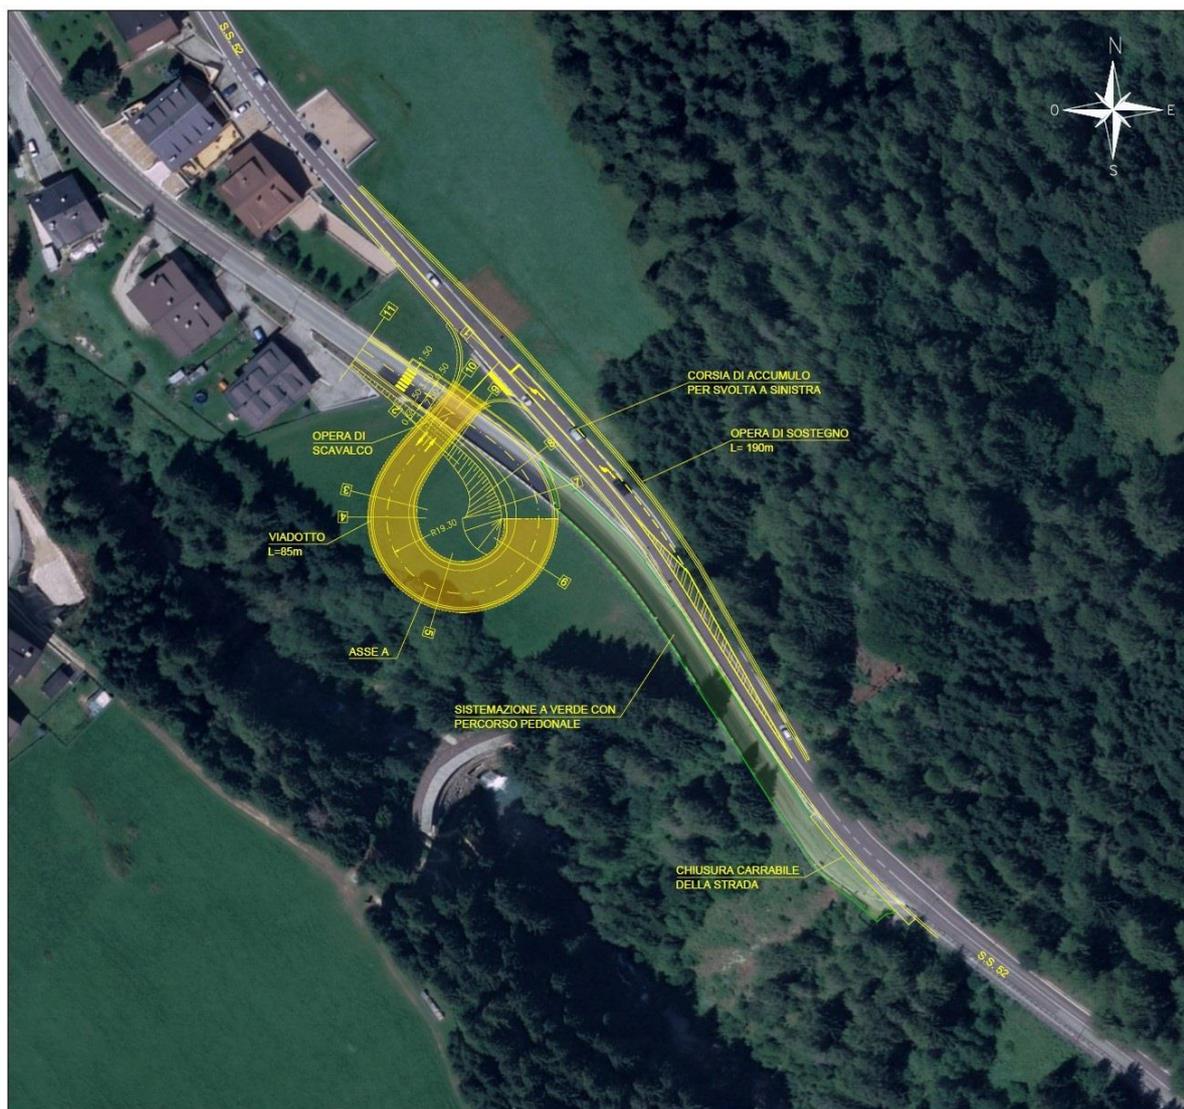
Planimetria di progetto su ortofoto Alternativa A
